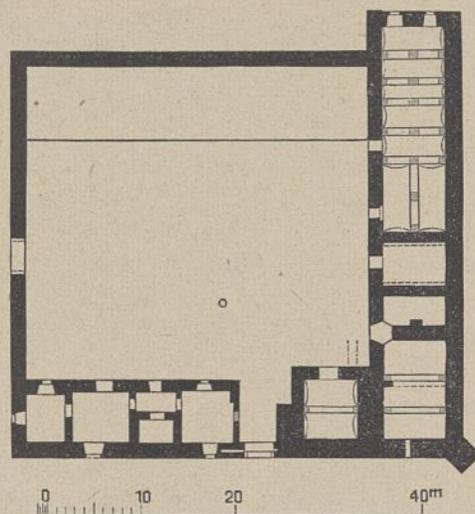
Das Ordenshaus in Hasenpoth. Erdgeschoßgrundriß. 1:300.
